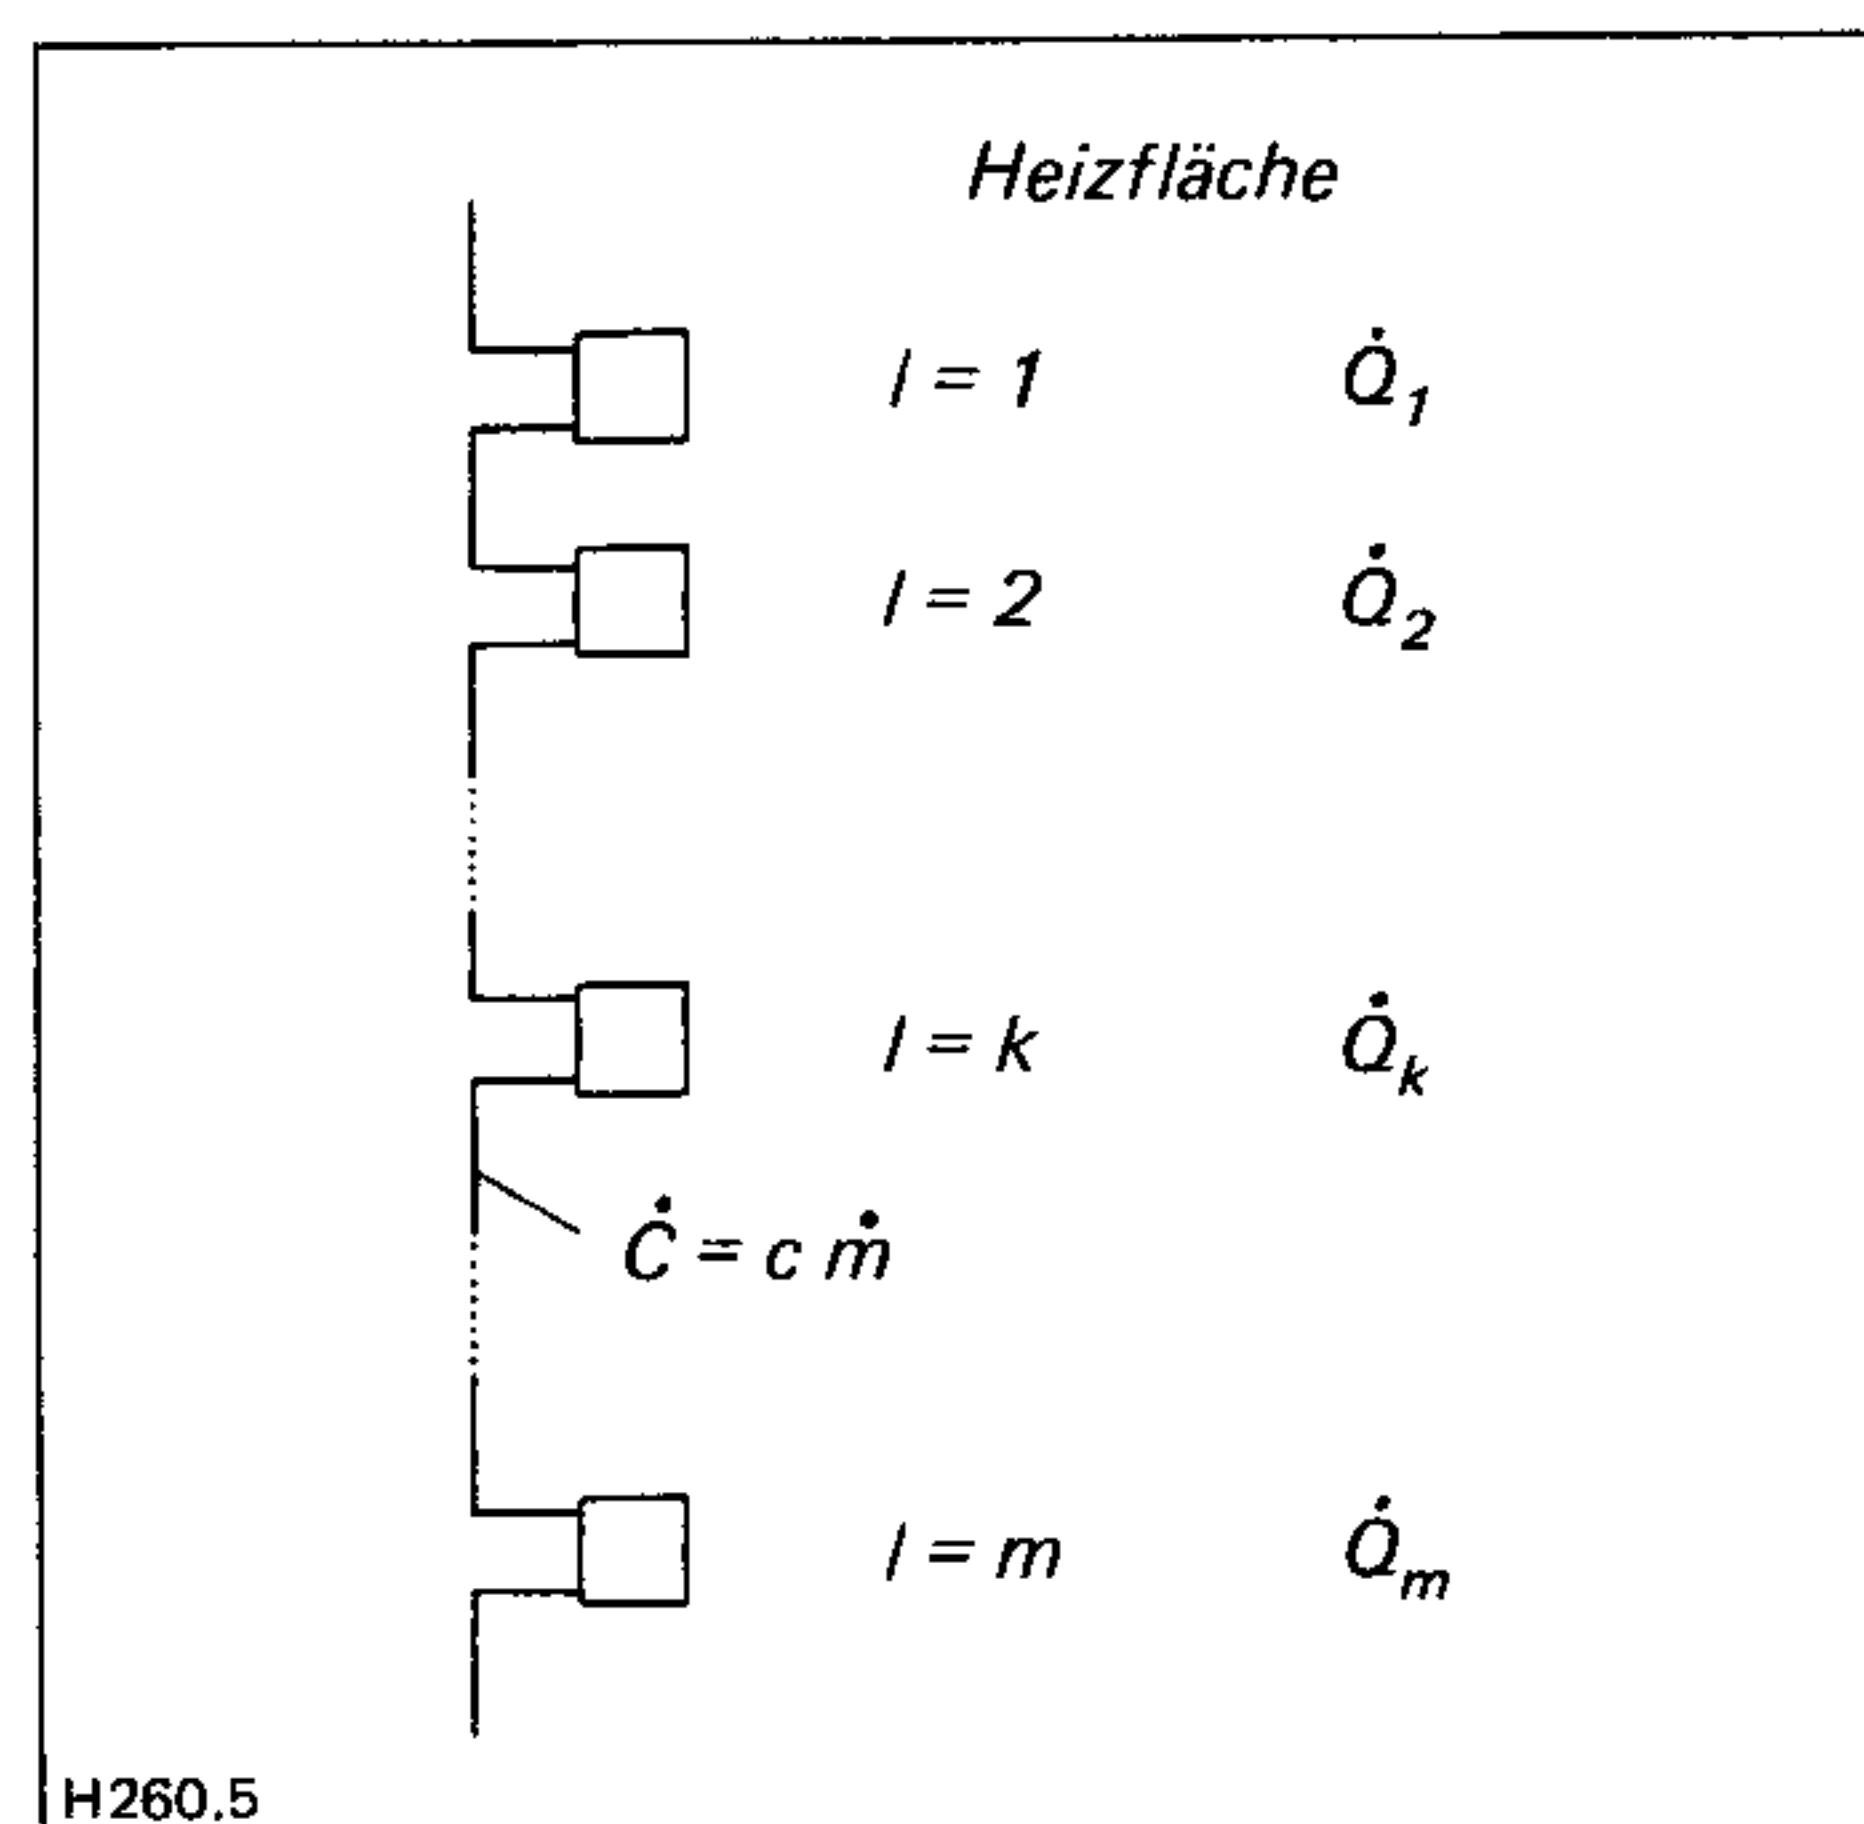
Einrohrstrang mit vollbeaufschlagten Heizflächen
